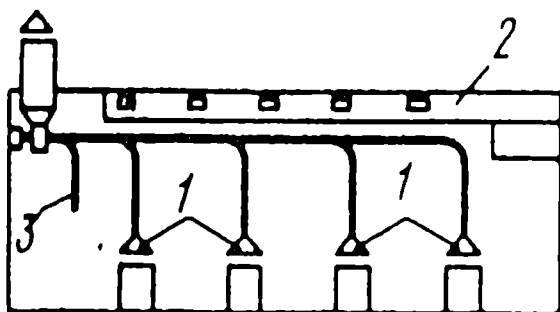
Схема смешанной вентиляции, местной вытяжной и общей приточной: 1 – местная вытяжная вентиляция; 2 – общая приточная вентиляция для всего помещения (приточная камера не показана); 3 – отвлечение для осуществления общей вытяжки из помещения
